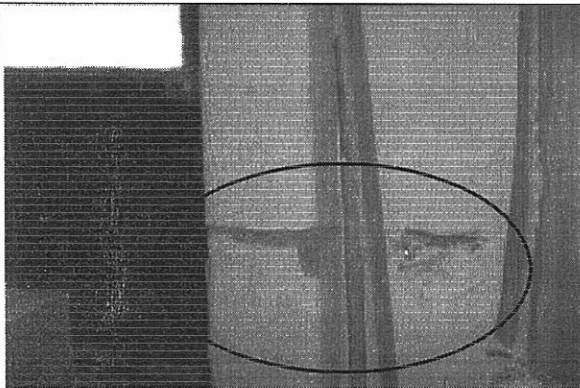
Agrietamiento cara interior del muro de fachada
